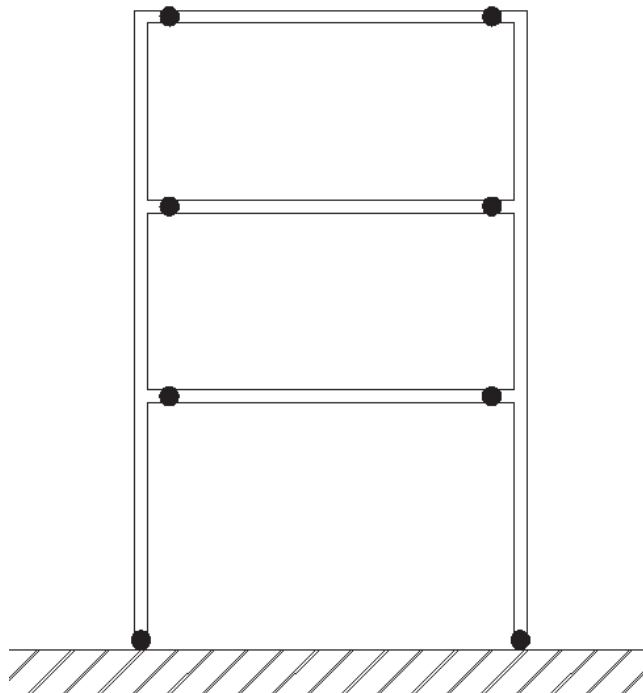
Formación de las rótulas plásticas en el mecanismo “viga débil - columna fuerte”
